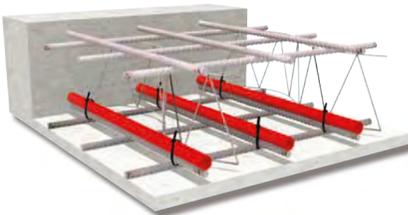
| Schemaskizze Bauteilaktivierung einer Geschoßdecke. © z + b
